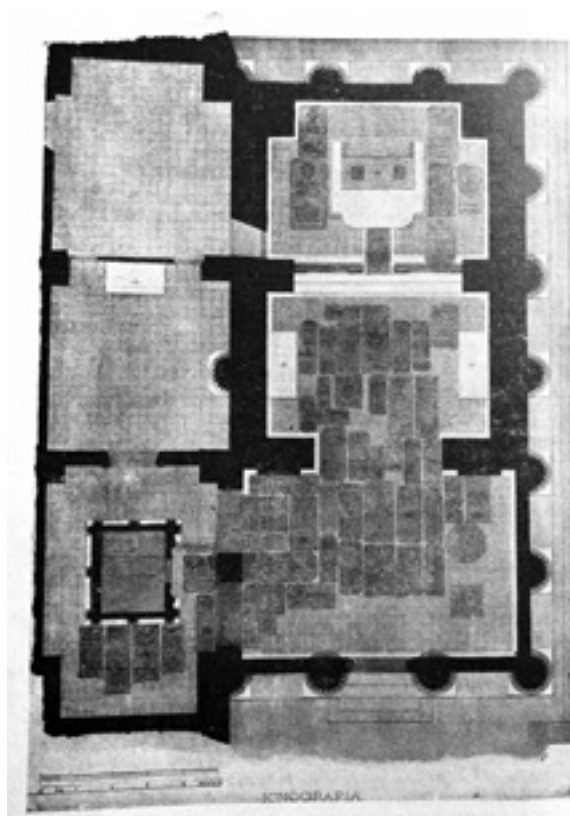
Pianta della chiesa di Santa Maria Egiziaca con il pavimento costellato di lapidi (fonte: Paterna Baldizzi 1933, p. 58, fig. 244).
